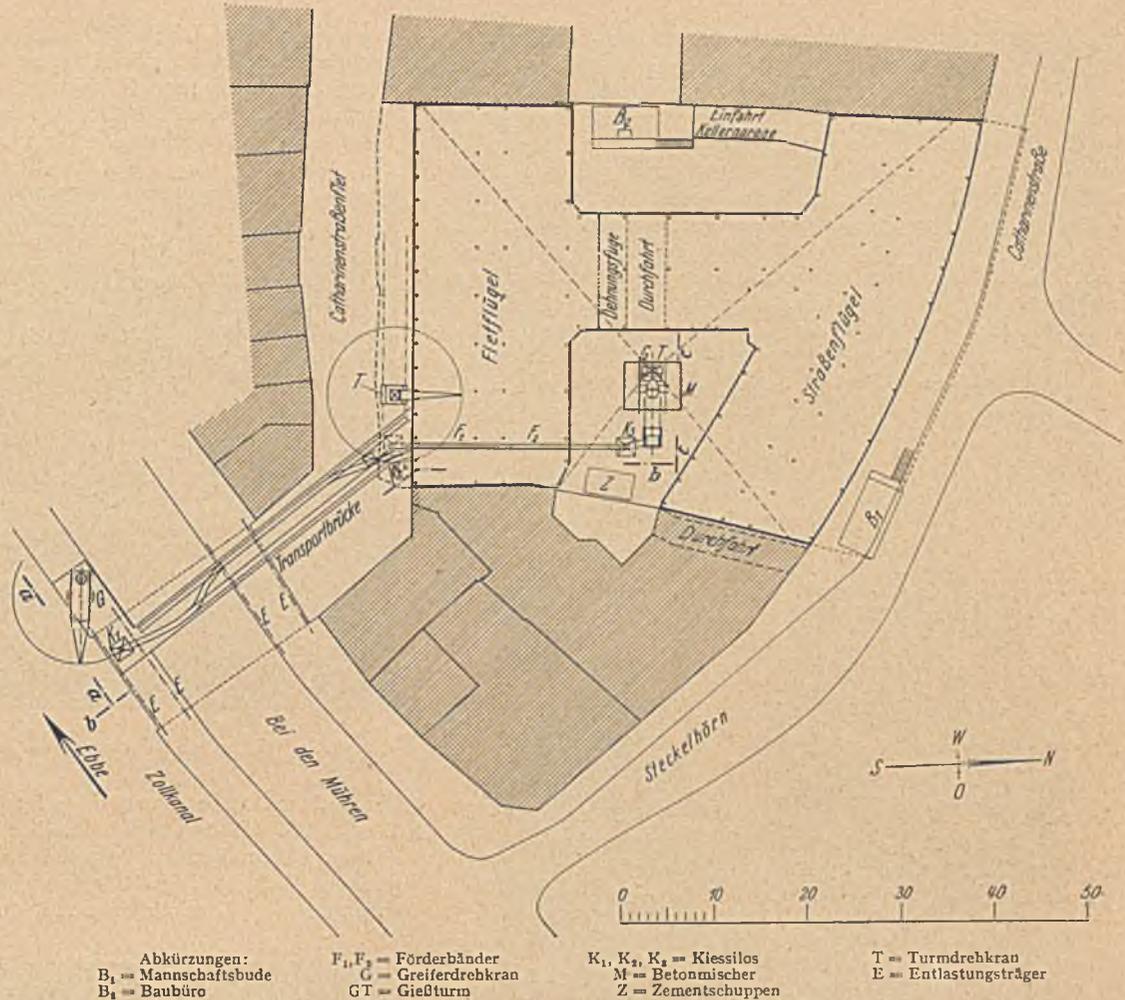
Lageplan und Grundriß der Baustelleneinrichtung.
